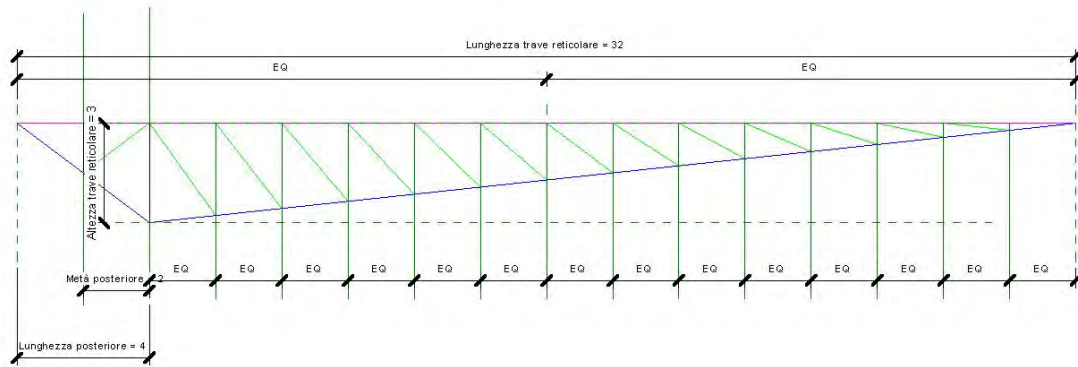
Famiglia della trave reticolare lunga 32m.
